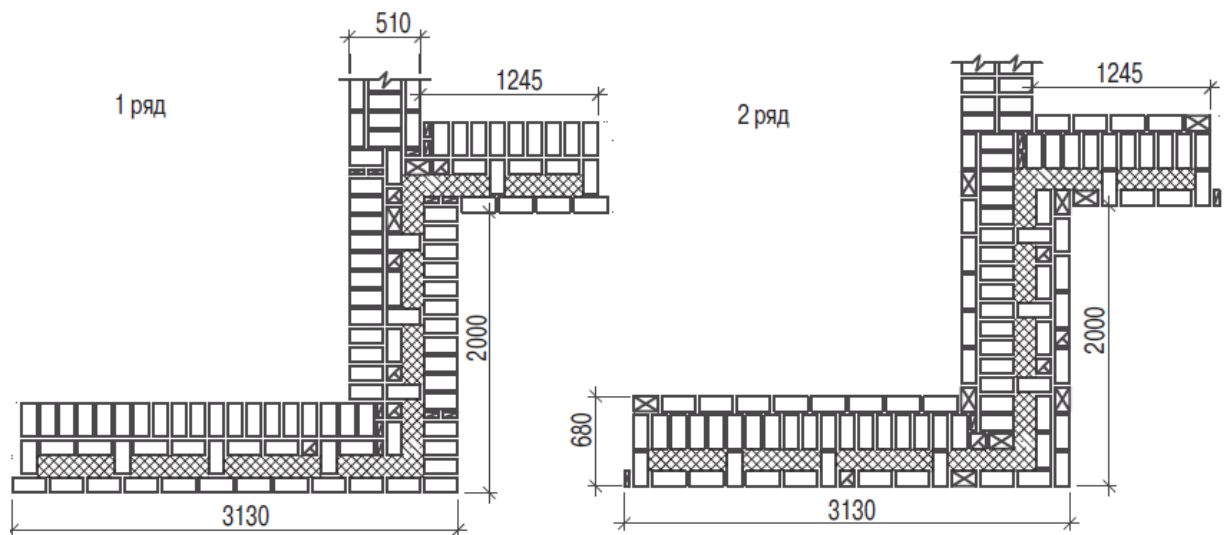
Фрагмент стен жилого дома с несущими и самонесущими наружными стенами в г. Раменское.
